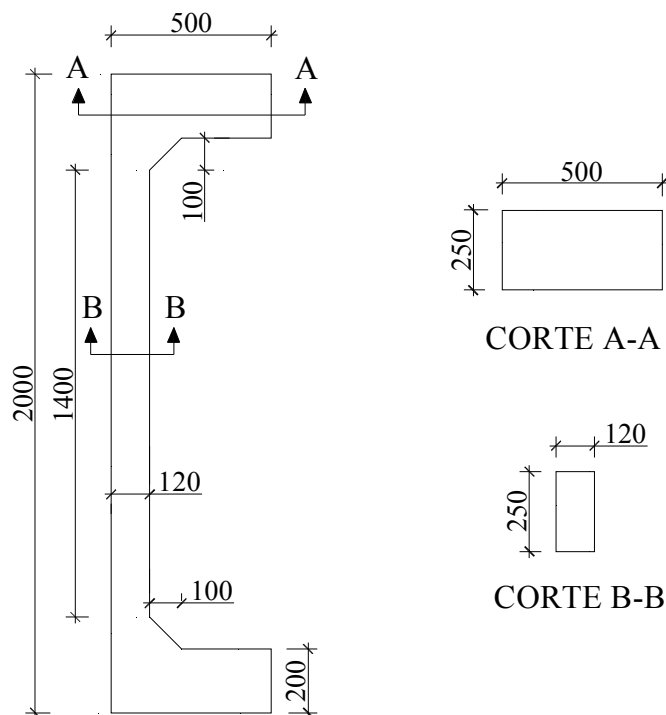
Dimensões dos pilares – ADORNO (2004)
